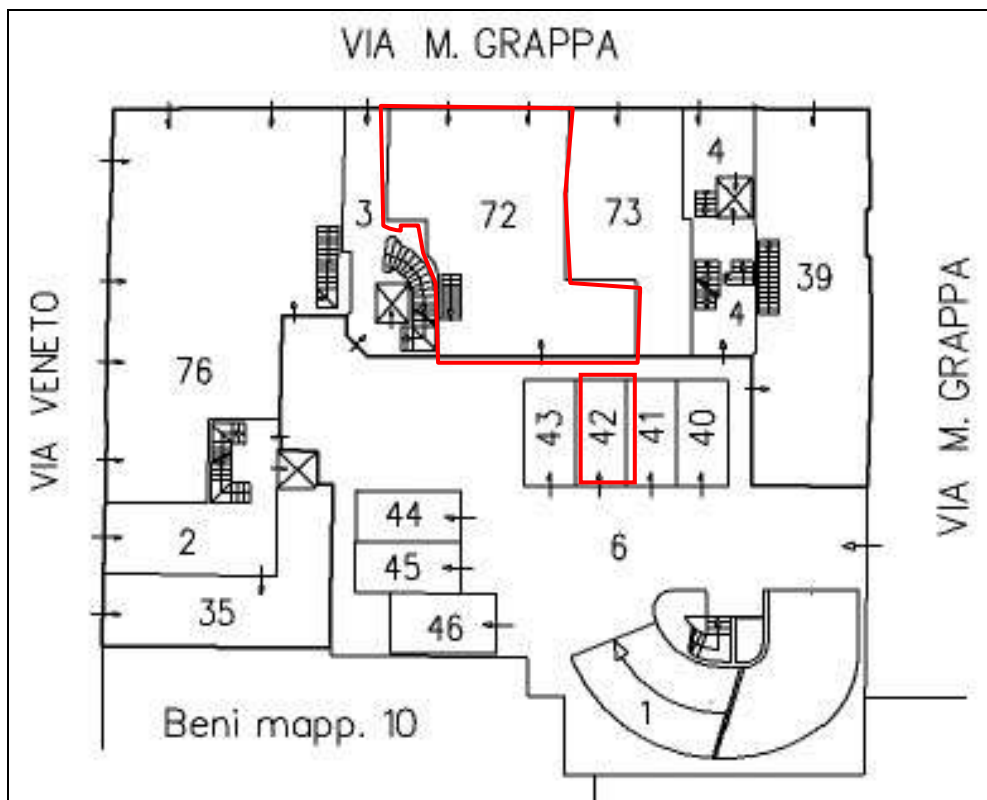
Estratto elaborato planimetrico – Sez. NCT fg.90 Part. 1 – piano terra
